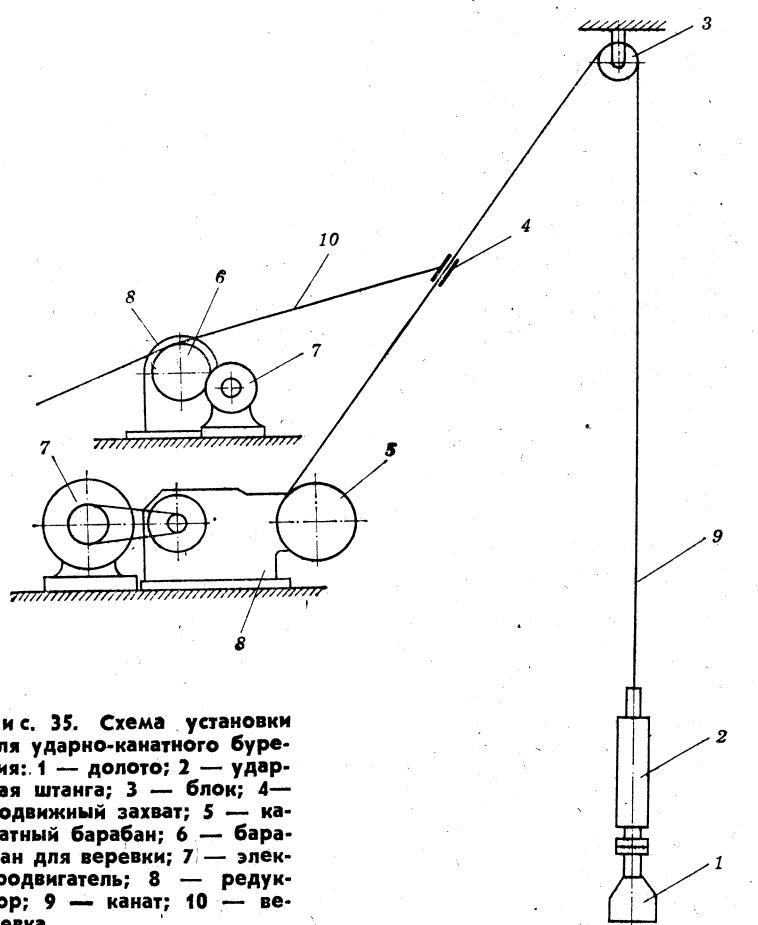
Схема установки для ударно-канатного бурения: 1 — долото; 2 — ударная штанга; 3 — блок; 4 — подвижный захват; 5 — канатный барабан; 6 — барабан для веревки; 7 — электродвигатель; 8 — редуктор; 9 — канат; 10 — веревка
